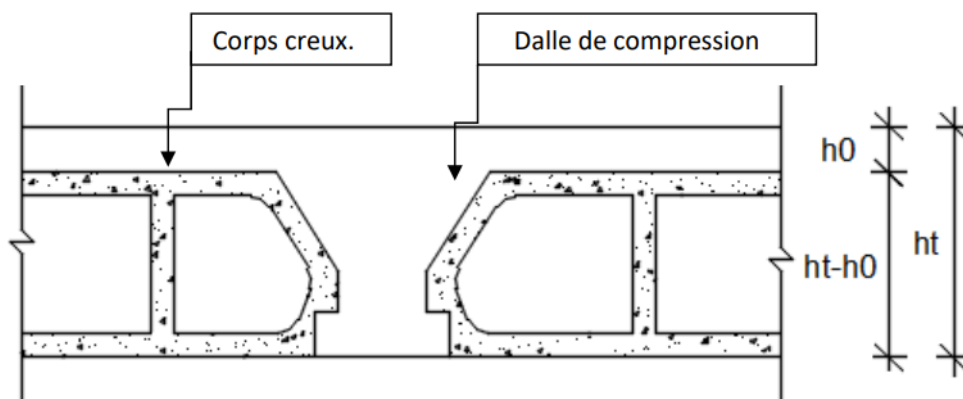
Coupe transversale d'un plancher à corps creux.
